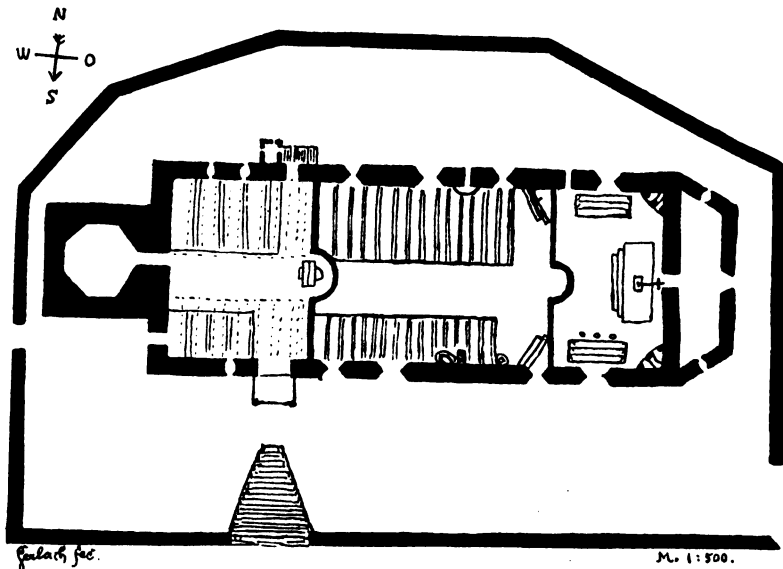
Plan der alten Kirche zu Vauchoheim.
